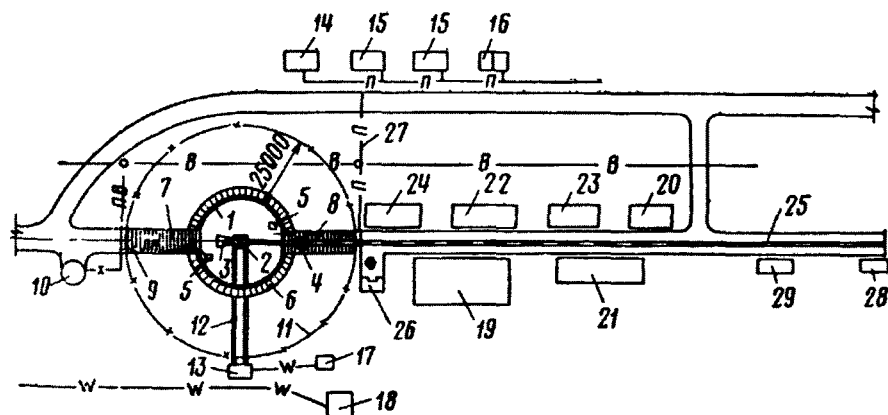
Стройгенплан возведения монолитной железобетонной трубы:
